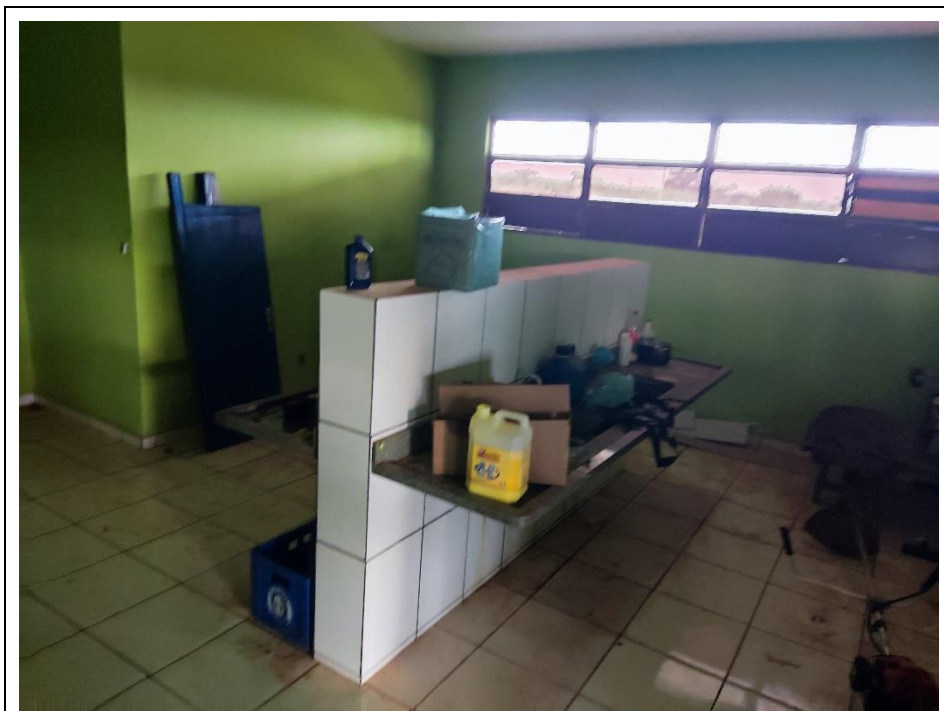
Prédio para locação em Paranatinga – Copa. Foto em 14/03/2024.
